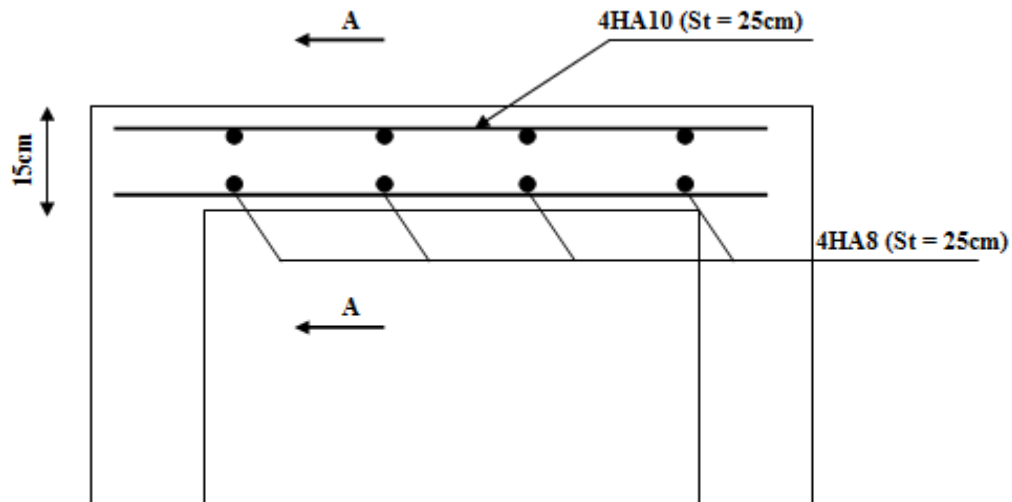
Ferrailage de la dalle de la salle machine
